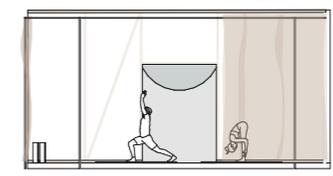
Bewegung: Grundriss und Schnitt
